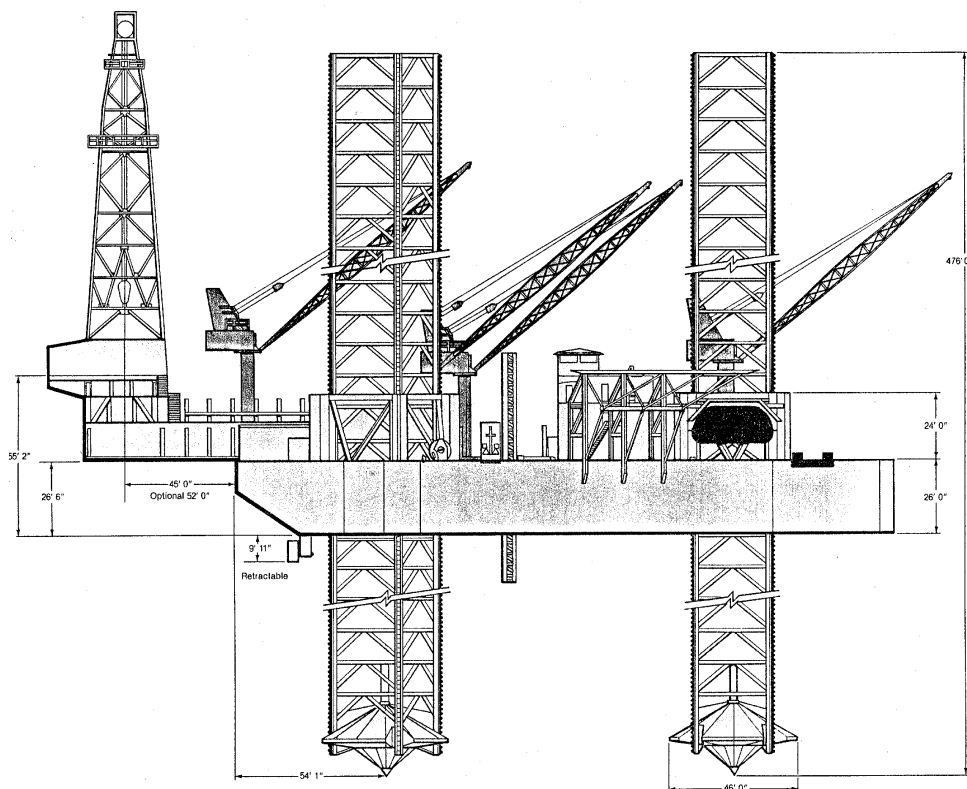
Plataforma Auto-Elevatória (Perfuração de Poços)
